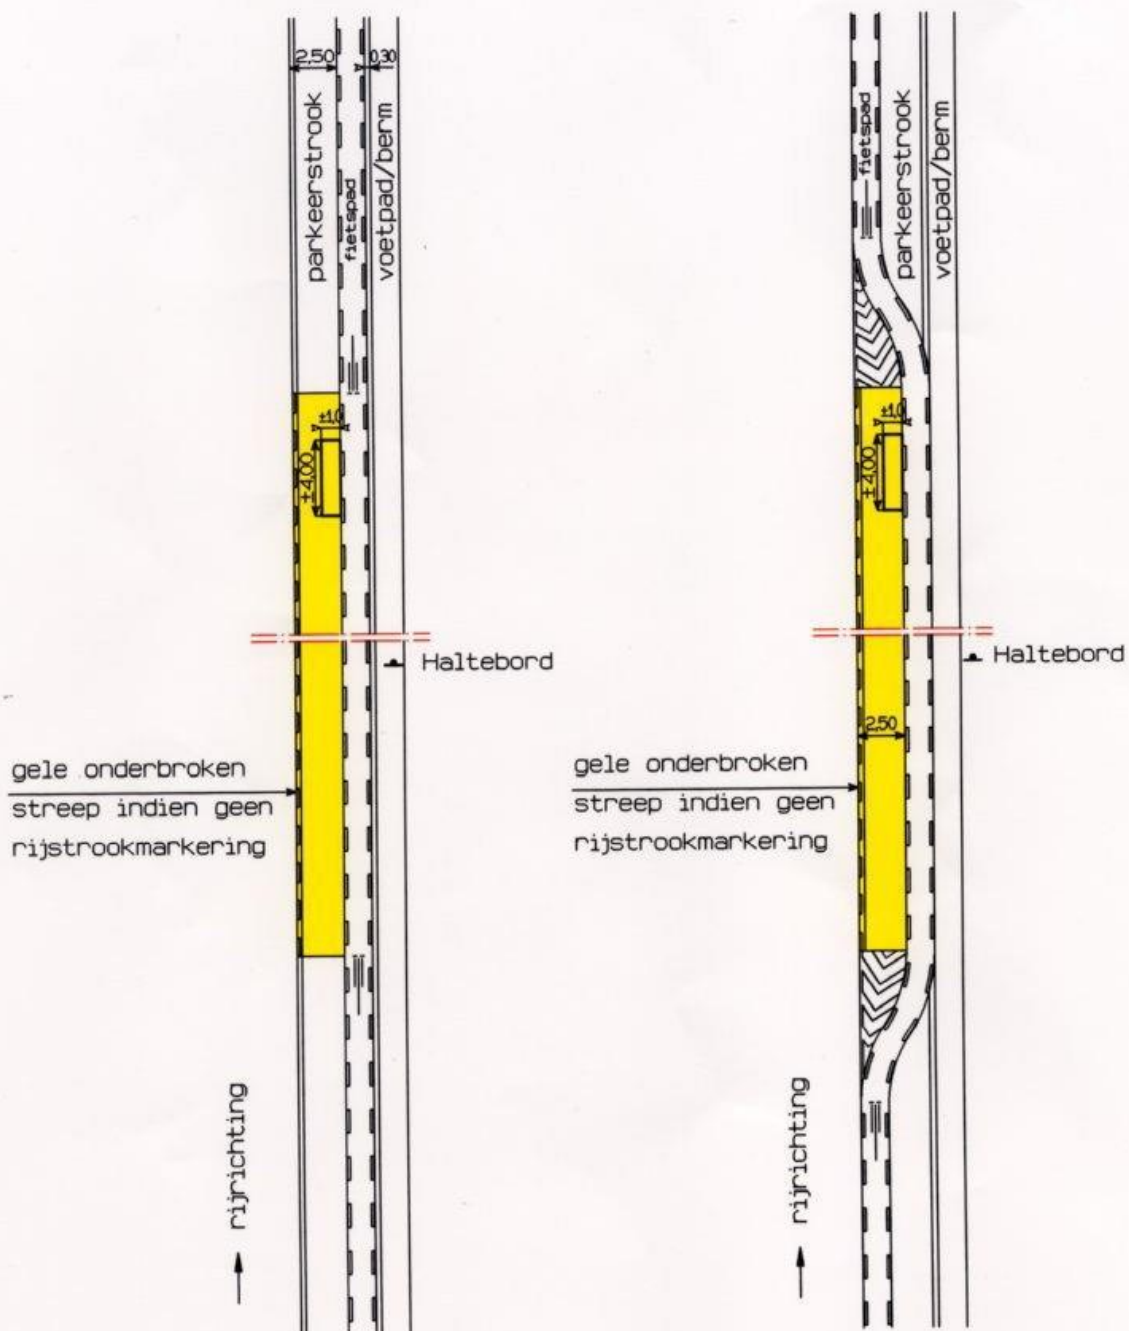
Detail halte buiten rijbaan – met voor- of achterliggend fietspad
